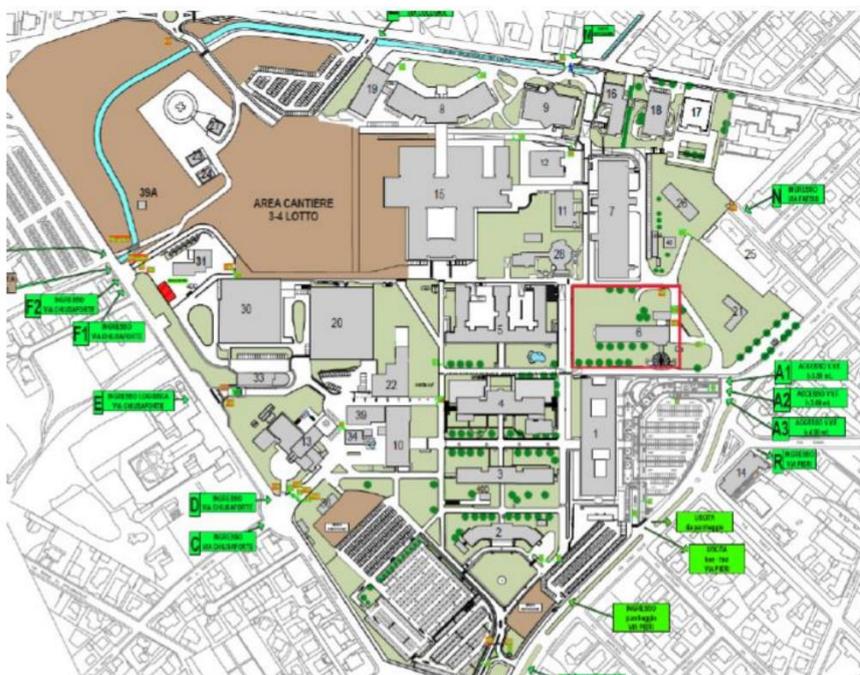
Planimetria generale del comprensorio (in rosso il riquadro dell'intervento)
